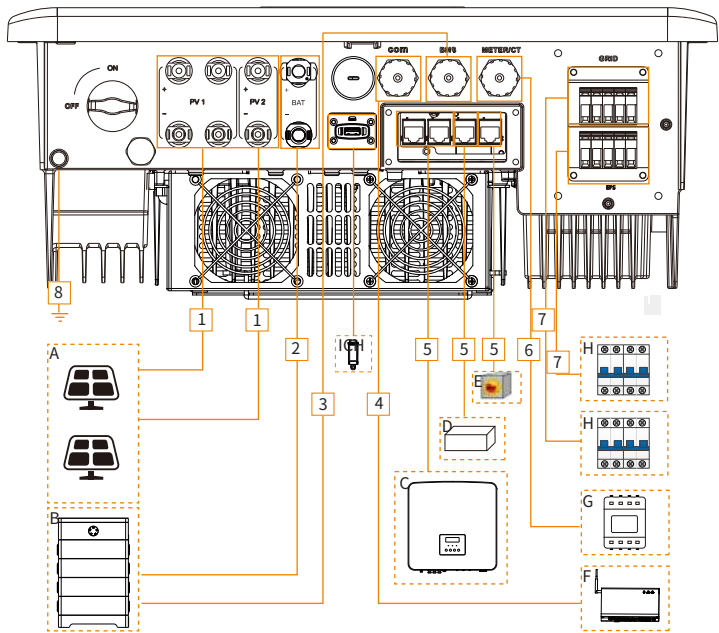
Kabelanschlüsse des Wechselrichters
